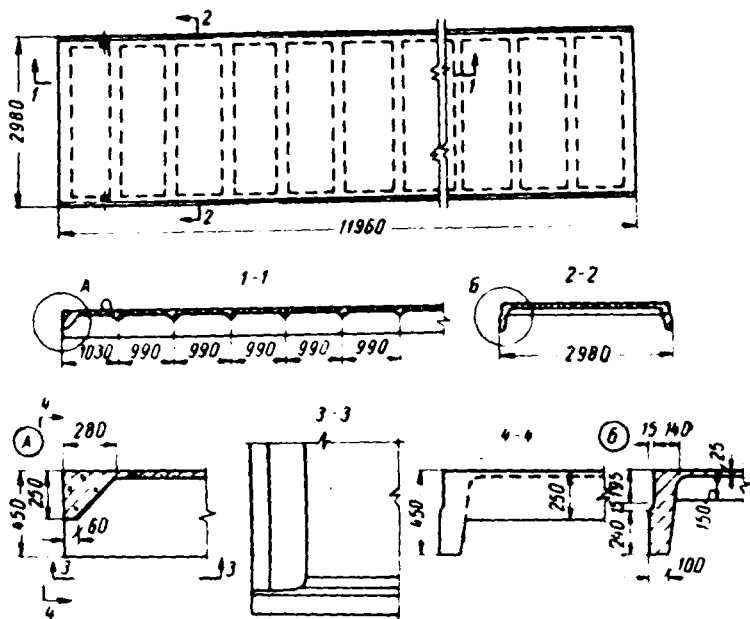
Типовая плита размером 12×3 м для изготовления на стенде (по чертежам 1962 г. до введения вутов)
